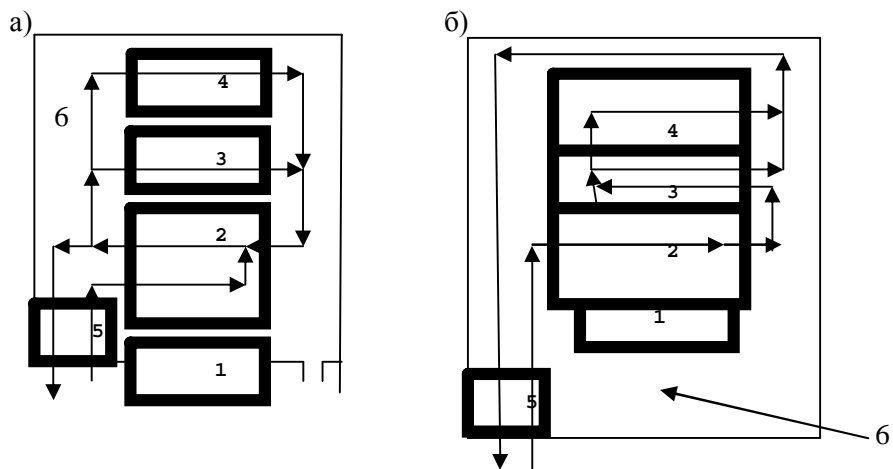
Способы застройки земельного участка: а - разобщенная, или павильонная, застройка; б - объединенная, или блокировочная, застройка; 1-административный корпус; 2-стоянка; 3-зона ТО; 4-зона ремонта; 5-КПП; 6-открытые стоянки.
